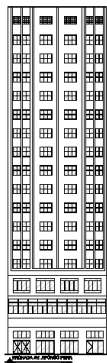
FACHADA HOTEL NORMANDY – AVENIDA AFONSO PENA – ELABORADO PELA AUTORA.
